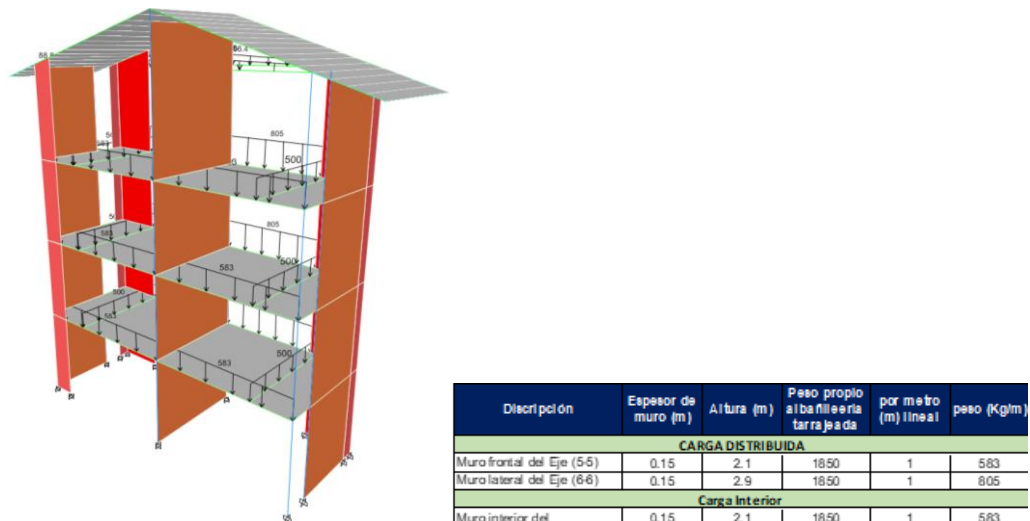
Cargas Distribuidas en Vigas en el Módulo N° 4
